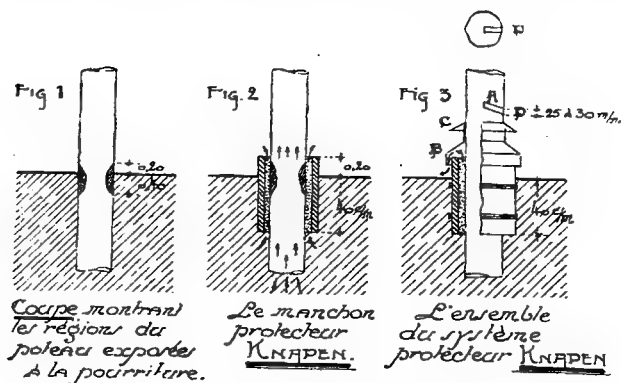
Coupes du manchon préservateur des poteaux en bois.
